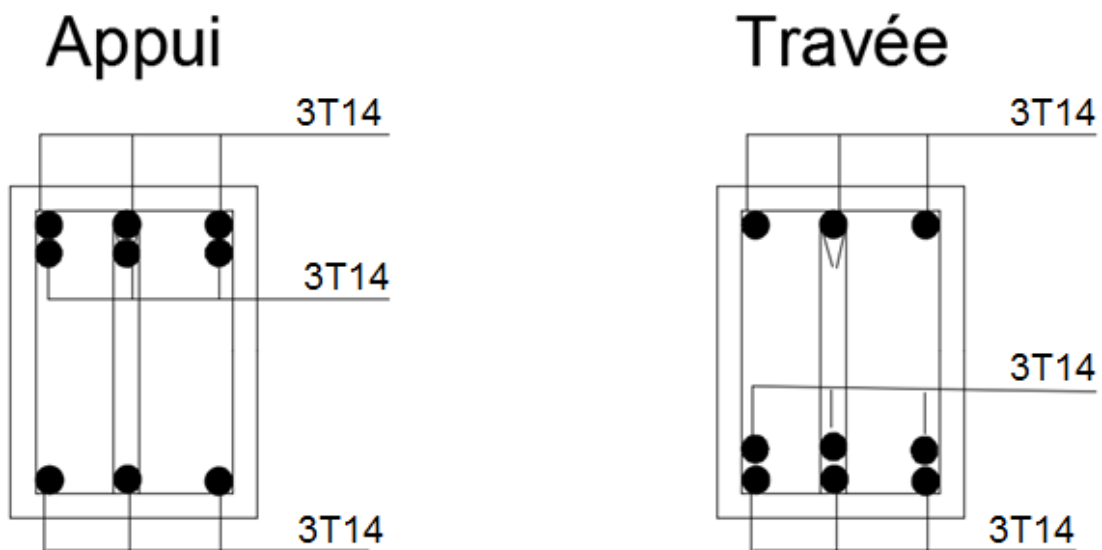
Schémas de ferrailage des poutres principales et secondaires
